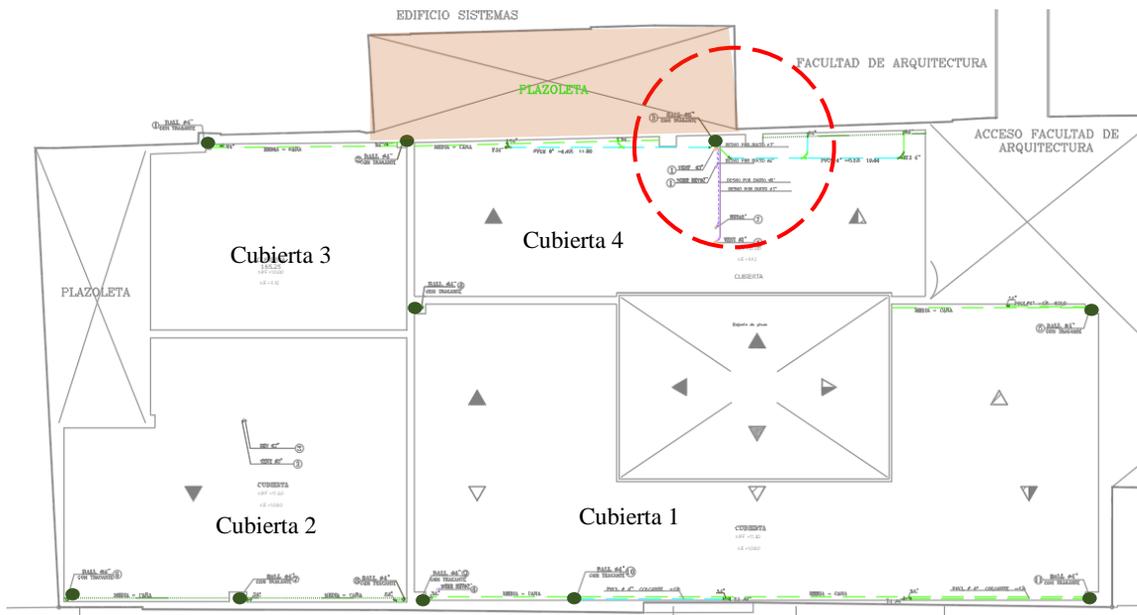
Bajante presentes en la cubierta, Adaptado de la planimetría del bloque I
